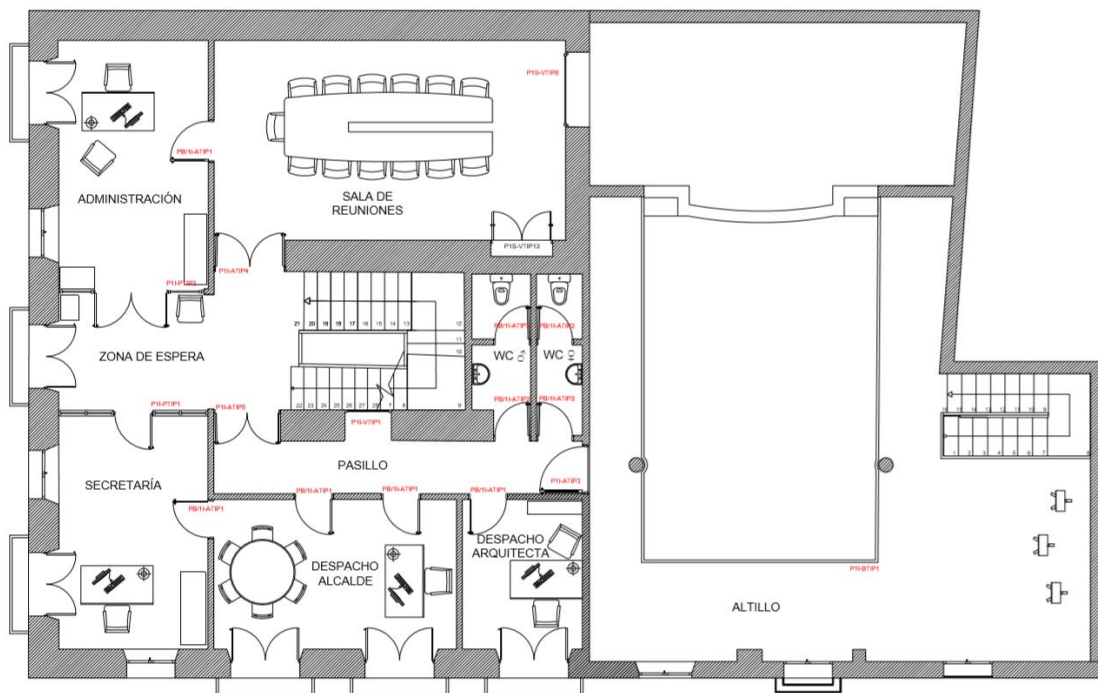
Plano planta primera. Estado actual 2019. Fuente: Elaboración propia, creación 21/06/2019
